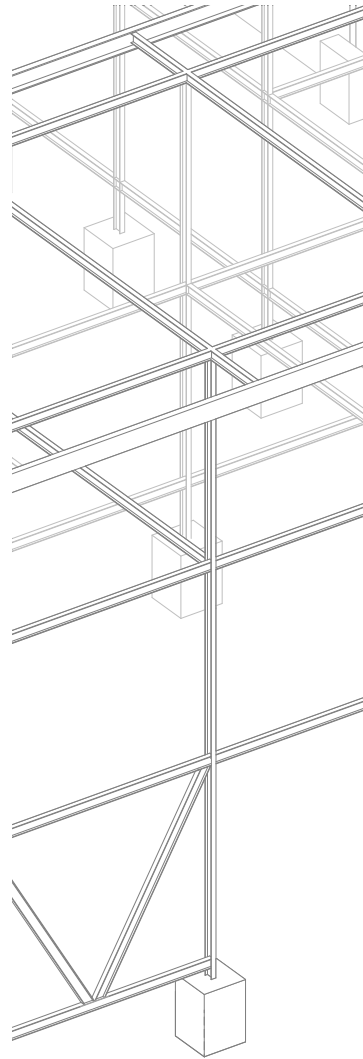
Craig Ellwood, Smith House (Glass House), LA, 1958, Axonometrie Tragwerk
